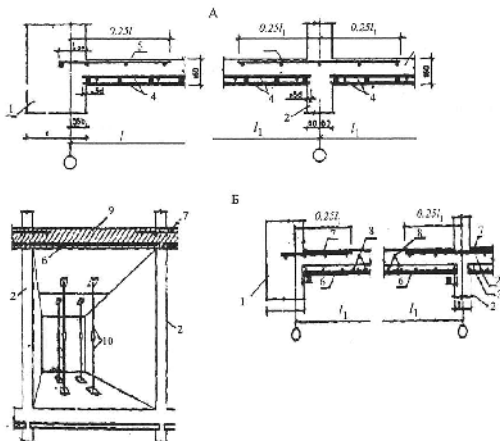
Монолитные и сборно-монолитные перекрытия: А – монолитные неразрезные перекрытия; Б – сборно-монолитные перекрытия; 1 – паружная стена; 2 – внутренняя стена; 3 – монолитная плита перекрытия; 4 – нижнее армирование; 5 – верхнее армирование (на опорах); 6 – сборная железобетонная "скорлупа"; 7 – верхняя арматурная сетка; 8 – нижняя арматурная сетка; 9 – монолитное перекрытие, 10 – телескопические стойки
